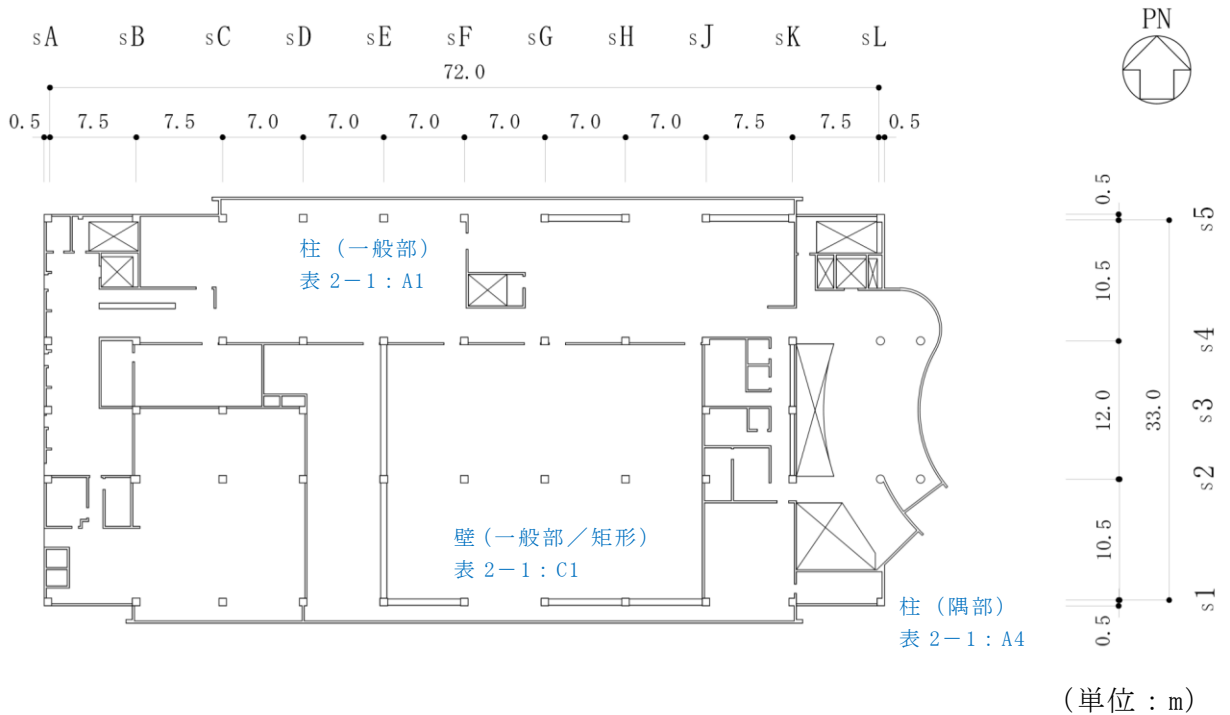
サービス建屋の概略平面図 (2F, T. M. S. L. 17.3m) (3/4)
